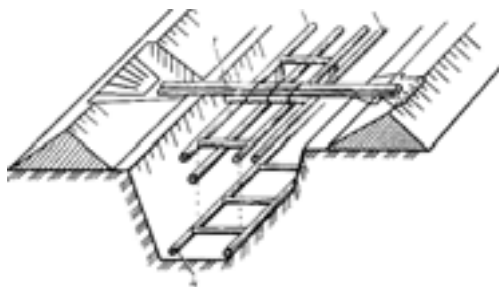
Укладка верхних и нижних опорных рам: 1 — удлиненные элементы наката; 2 — верхняя опорная рама; 3 — монтажные жерди; 4 — нижняя опорная рама
